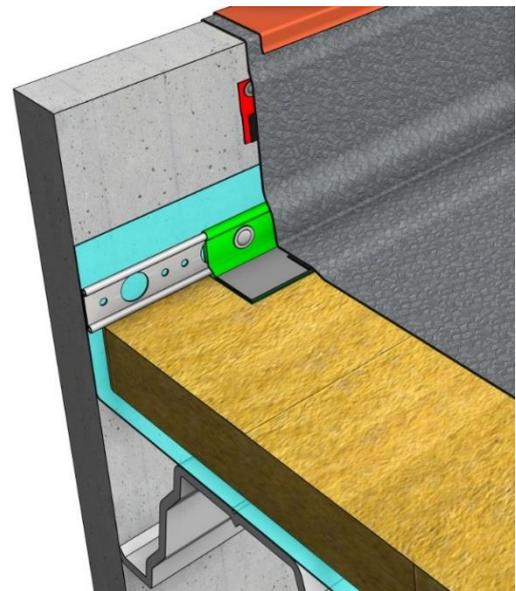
Fixation au droit du pied de relevé avec le système SECRET FIX POCKET + SECRET FIX STRIP (relevés de plus de 600 mm)
